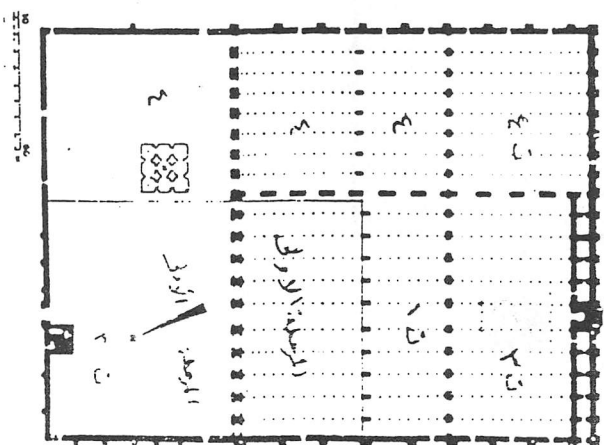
المسقط الأفقي لجامع القيروان في تونس .
